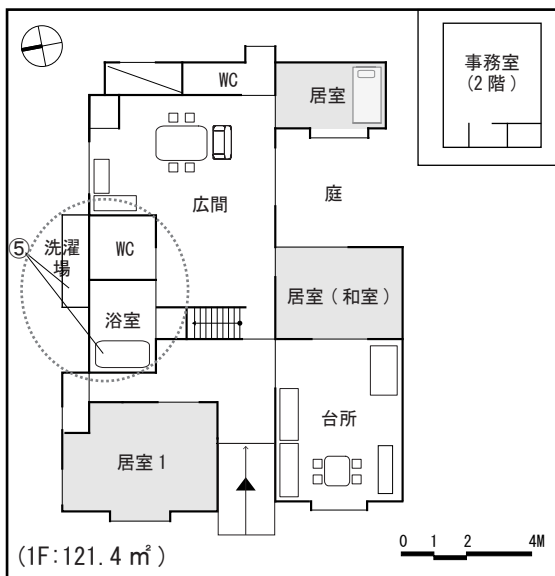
Y1 平面図 (⑤) [2001.8]
